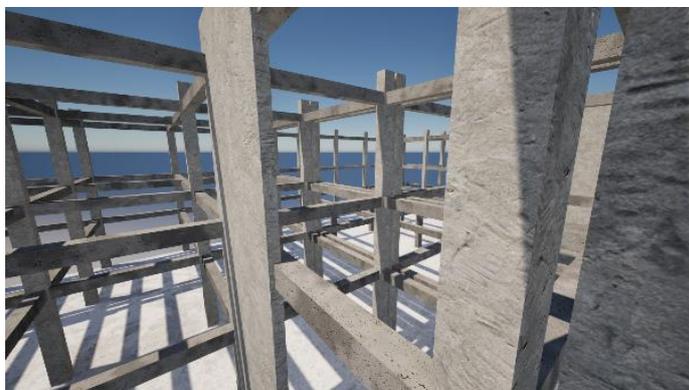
Structure en béton armé. Source : Auteurs 2025.
